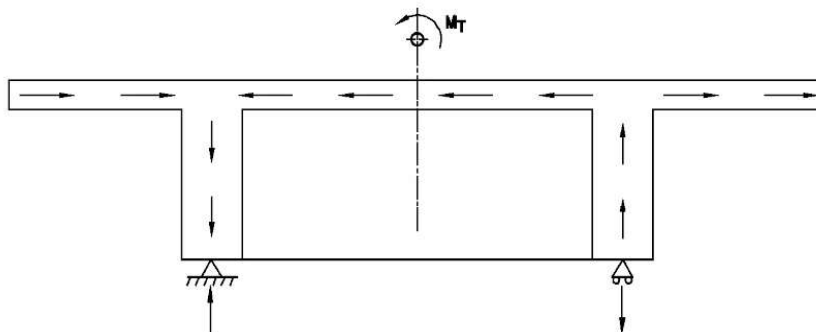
OO.10 Torsión del tablero y reacciones en los apoyos
